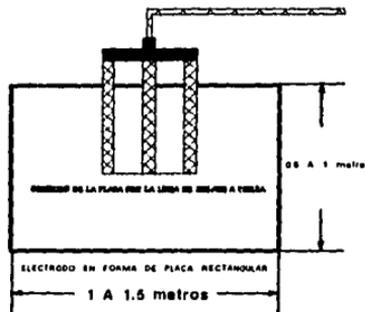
FORMA DE CONECTAR UNA PLACA RECTANGULAR CON LA LÍNEA DE ENLACE A TIERRA UTILIZANDO SOLDADURA DE ALTO PUNTO DE FUSIÓN.
